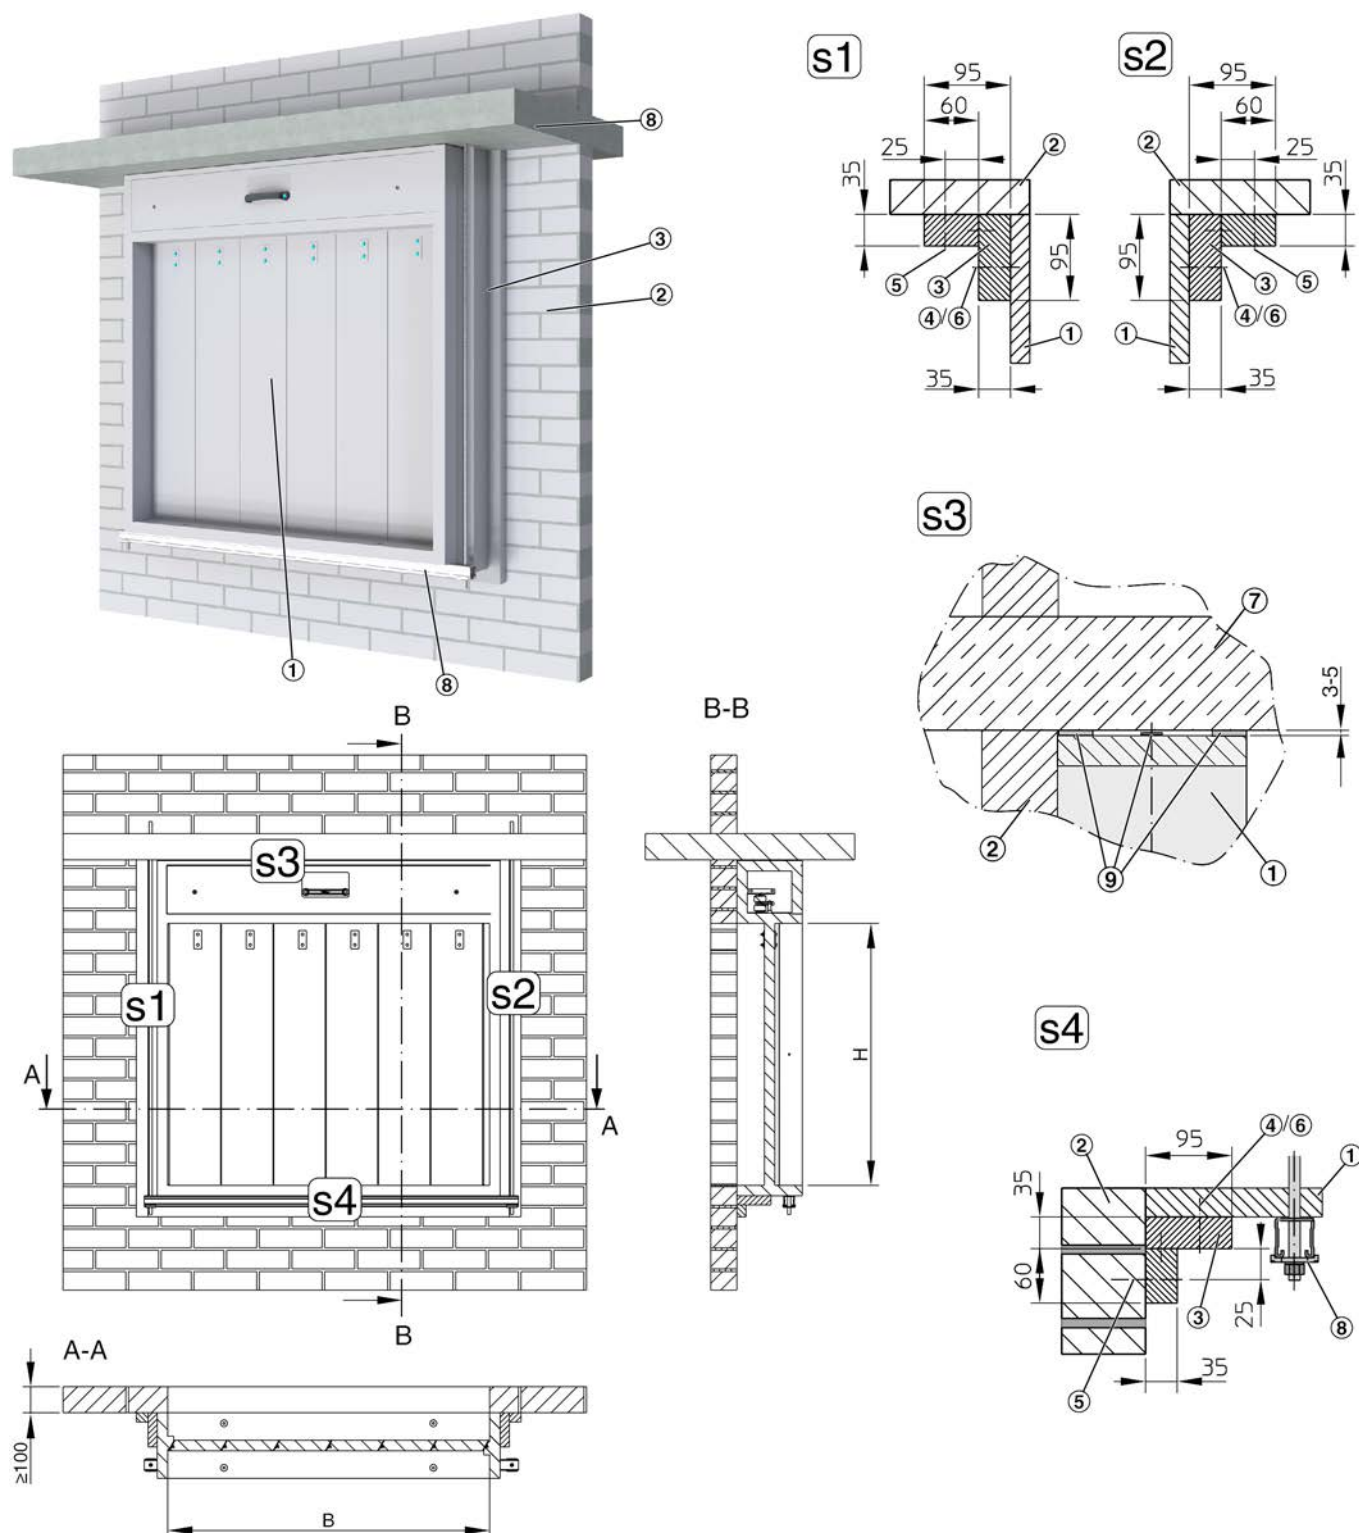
EK-JZ su parete cava/parete con distanza ridotta dalla soletta
